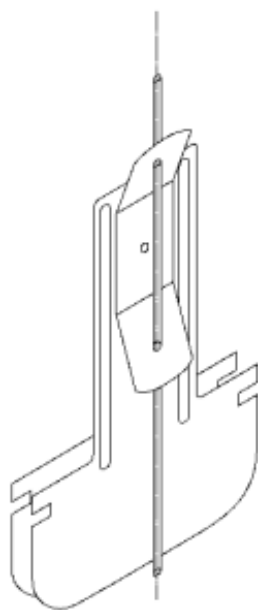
Тяга и подвес с замком для профиля ПП 60x27
